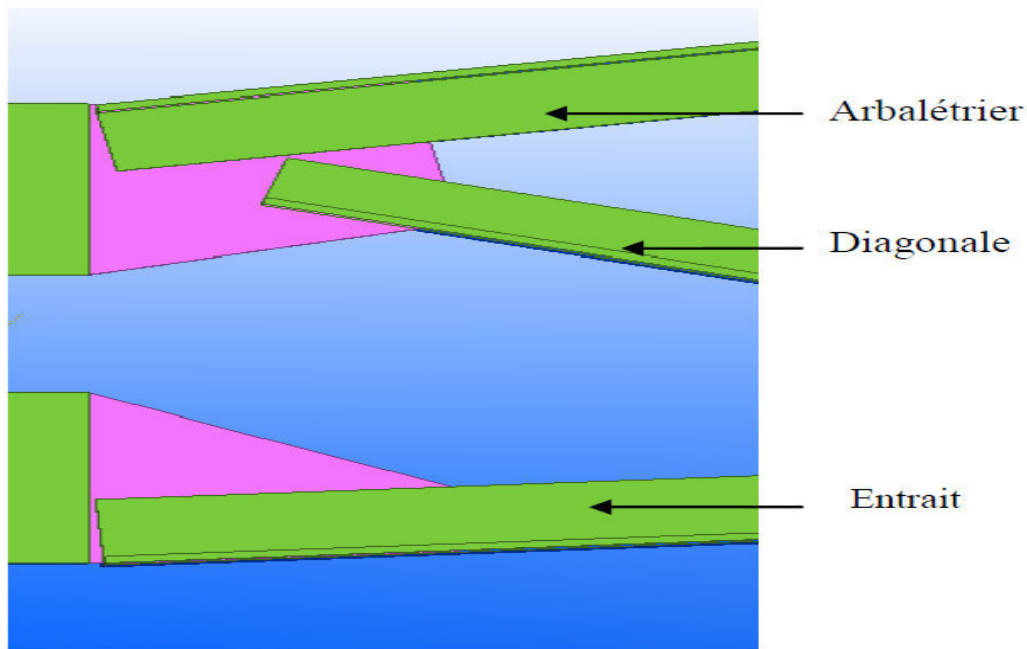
Assemblage des éléments de la ferme par soudage
